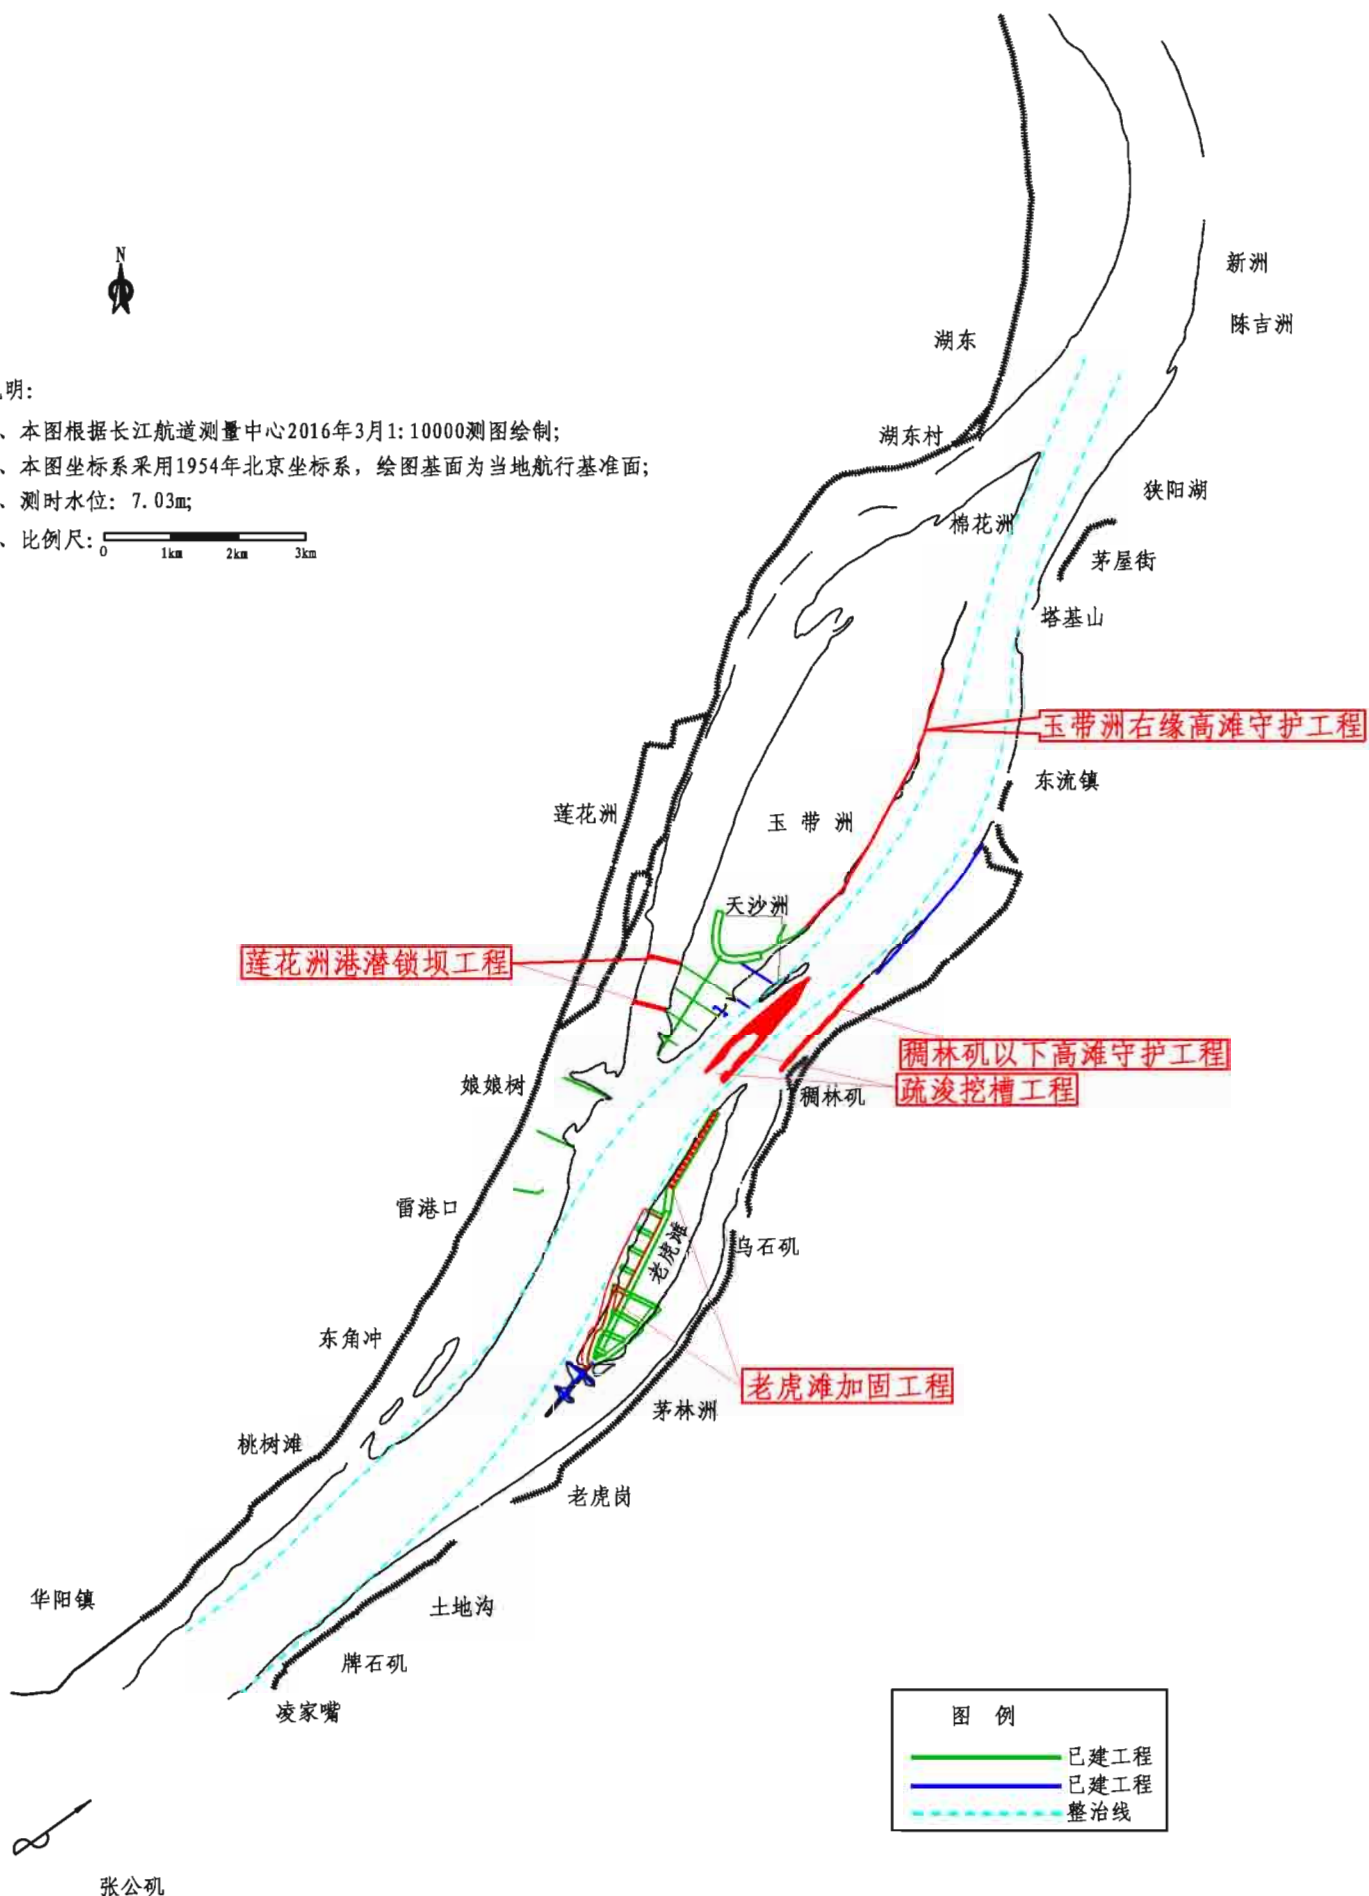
东流水道航道整治工程平面布置示意图 (方案二)
